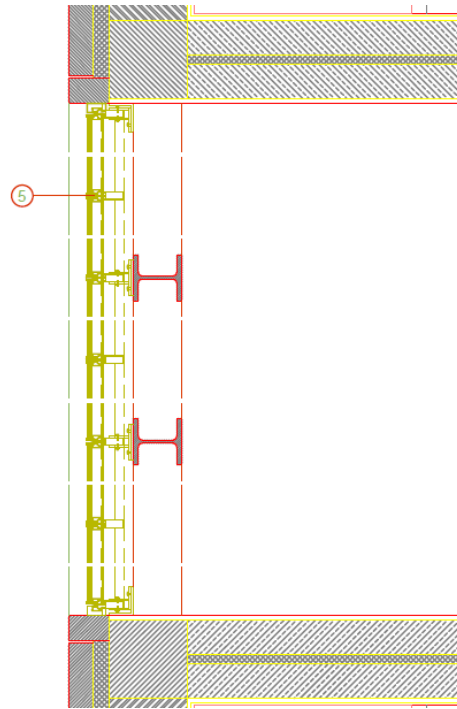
b) Pormenor construtivo da estrutura metálica da fachada de vidro, corte H1.
